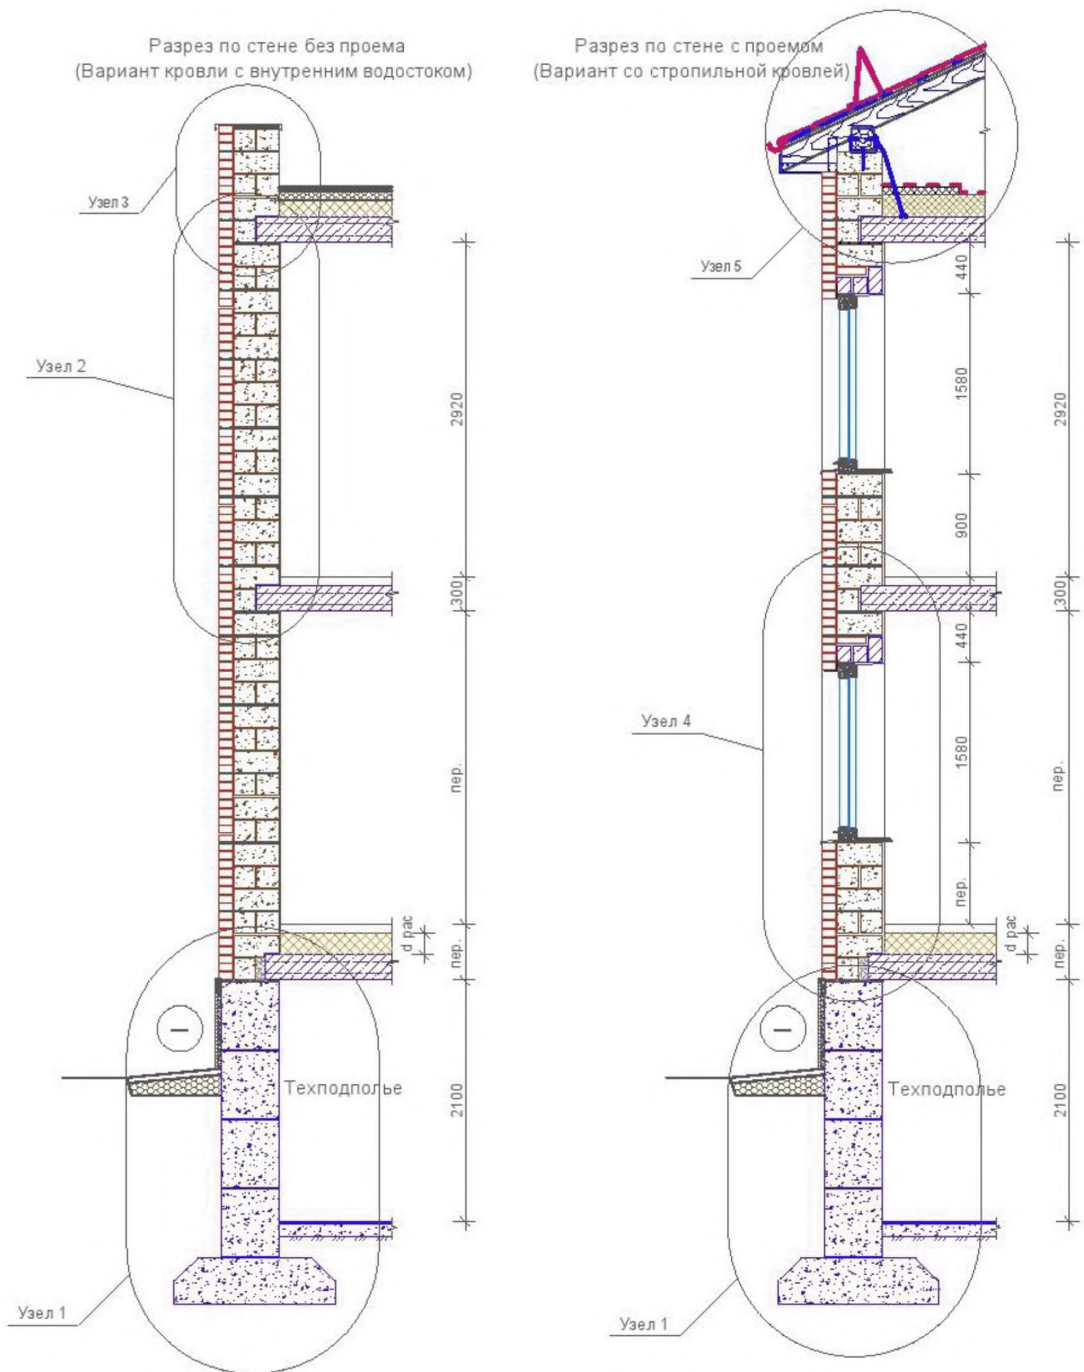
Схема нумерации узлов на поперечном разрезе здания
